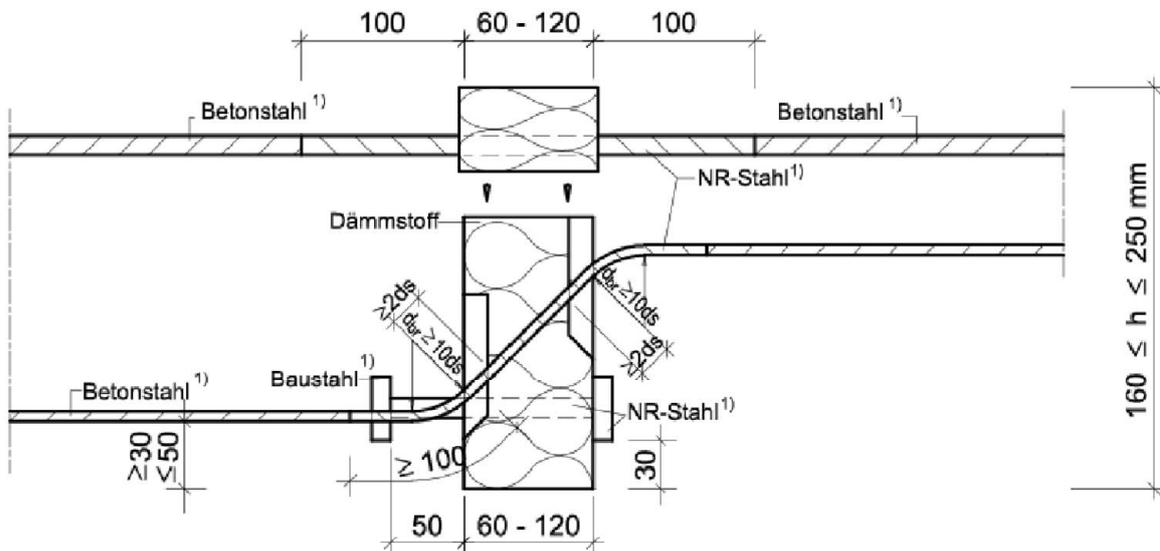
Schöck Isokorb® Typ Q-ID mit
